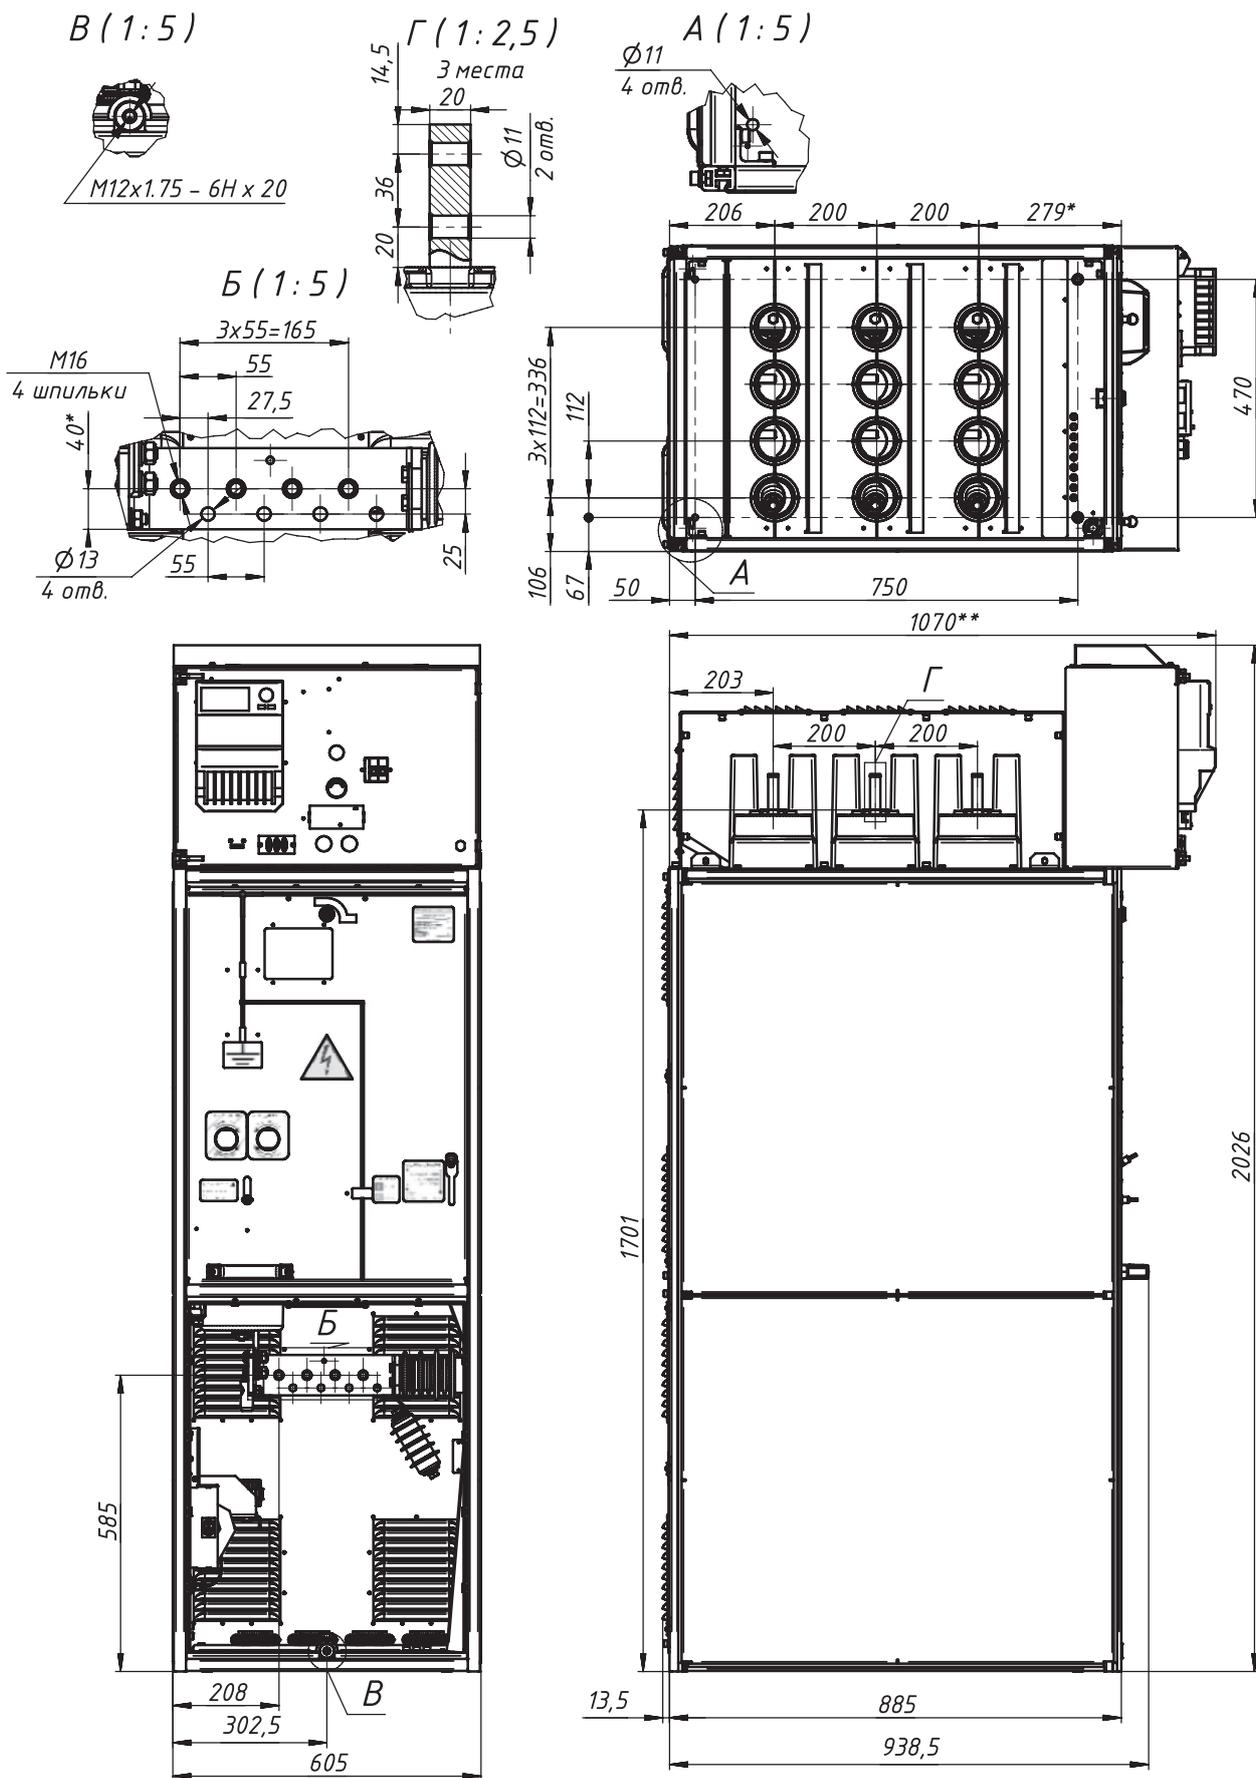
КРУ/Вертикаль-10-31,5/2000. Габаритный чертёж
